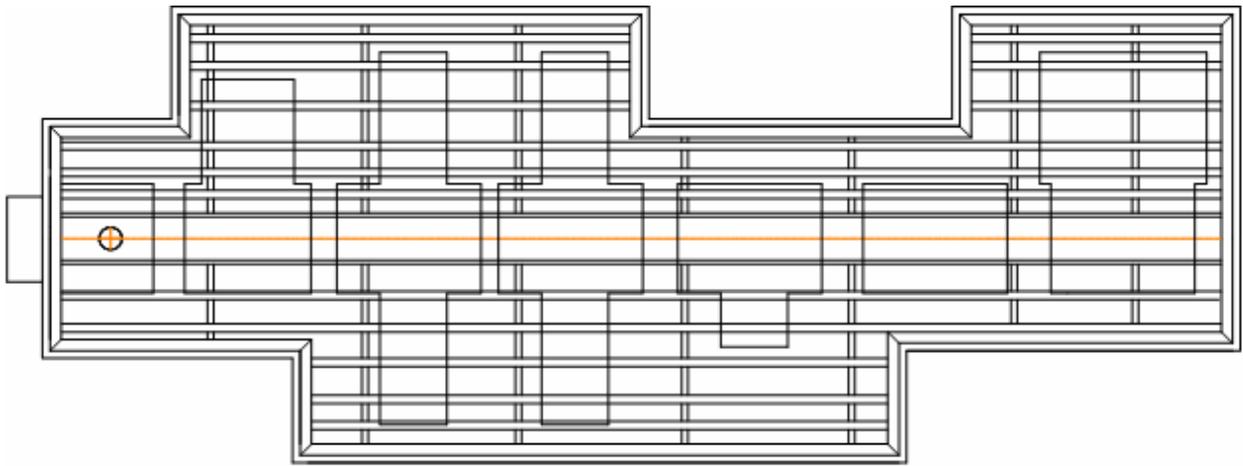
Балочный настил фундамента автоматической линии
